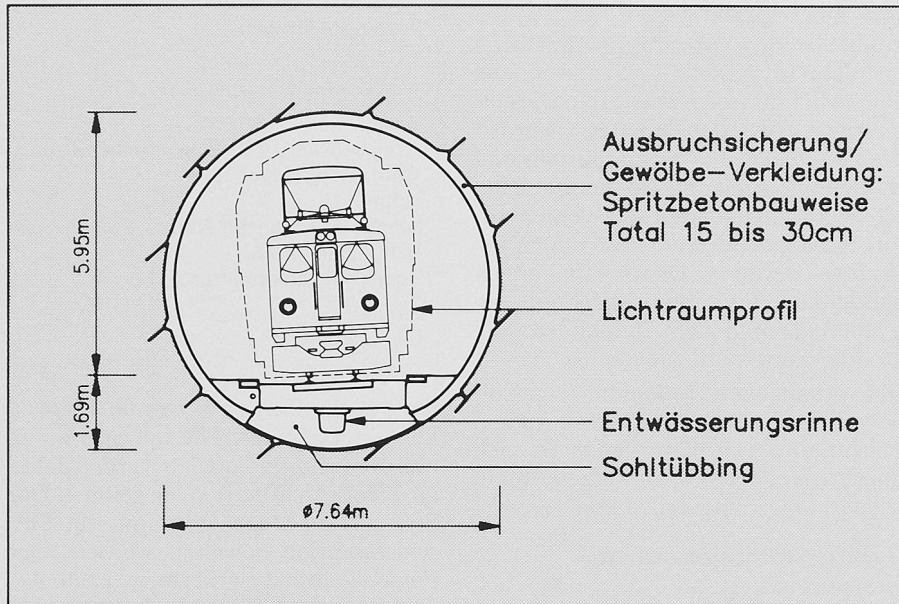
Normalprofil des Zugwaldtunnels (Baulos T4a)
